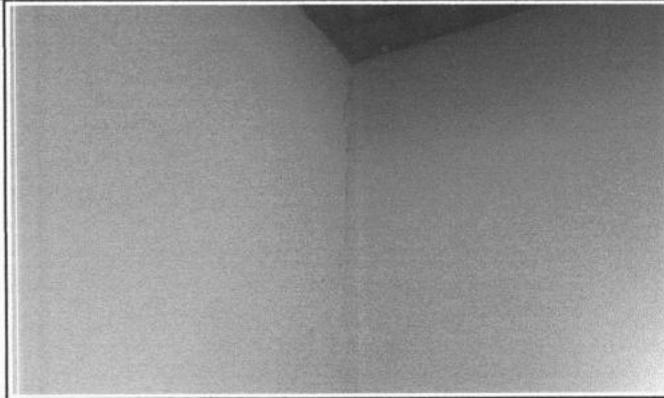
RECUPERAÇÃO DE RACHADURAS
